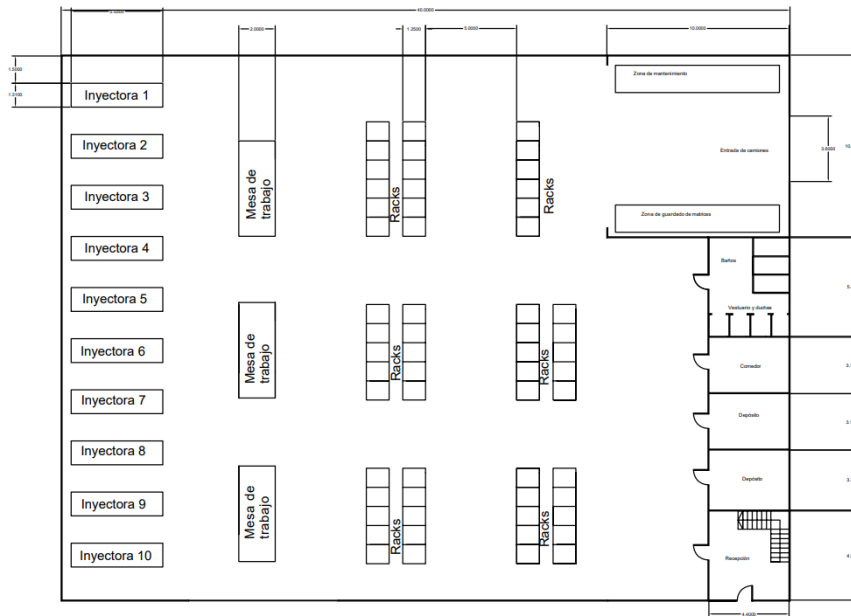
Plano de planta actual (Fuente: elaboración propia)
